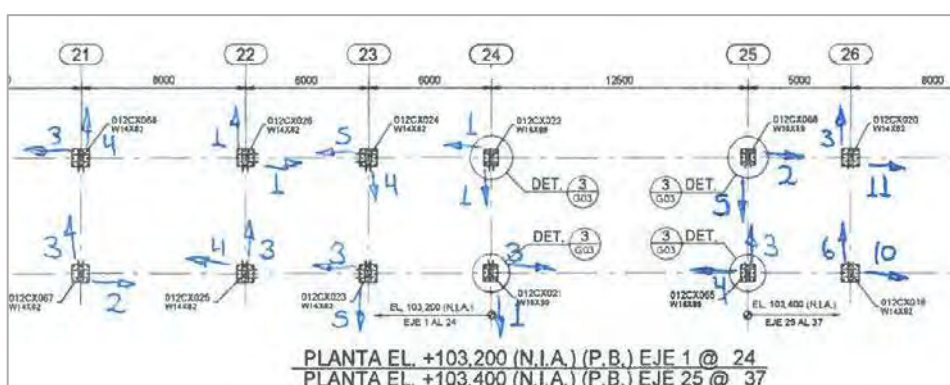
Plano de vista de planta, el cual indica la dirección de las desviaciones
